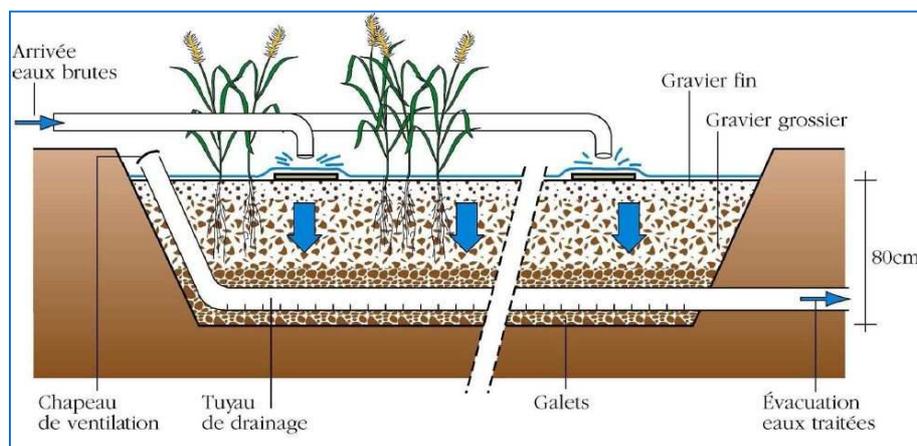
SCHEMA D'UN FILTRE PLANTE A ECOULEMENT VERTICAL [29]
